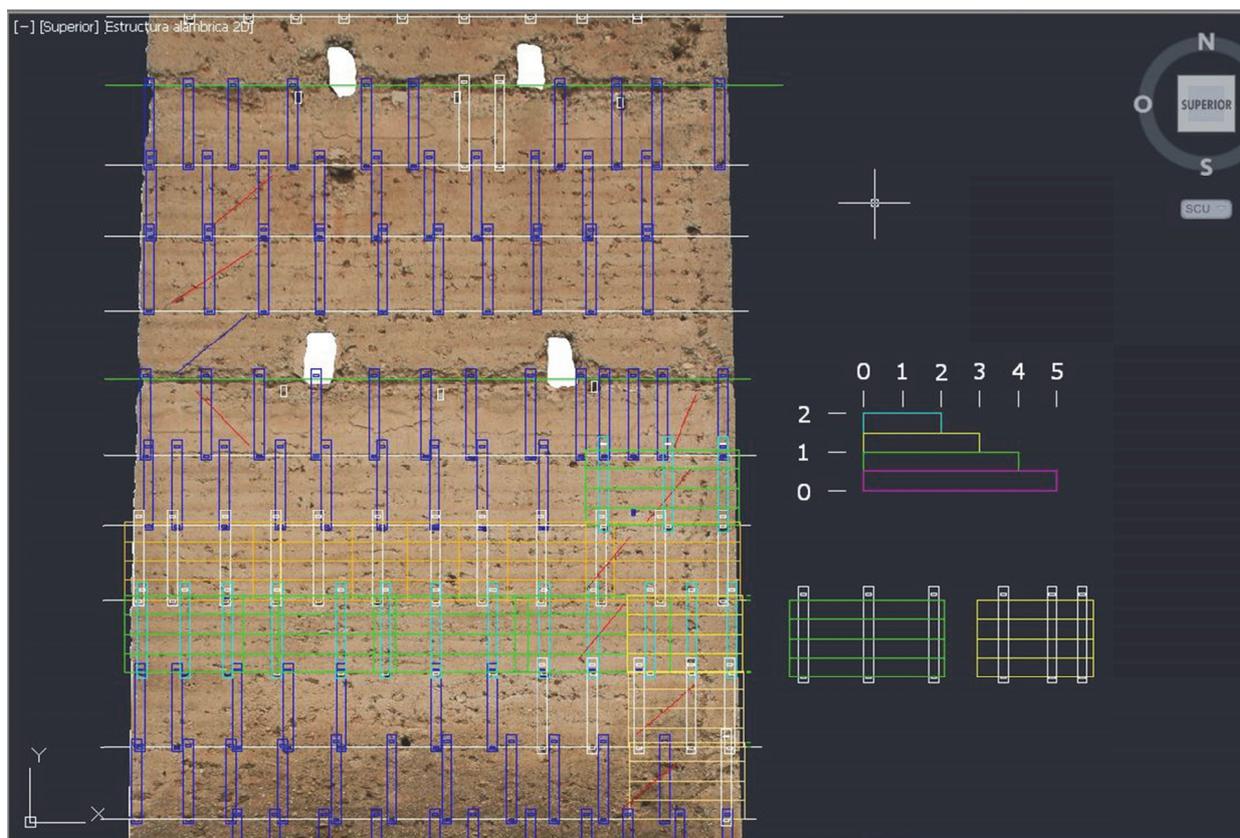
Superposición del módulo de tapial ideal sobre los alzados de la torre con la imagen fotogramétrica rectificada, en la que puede apreciarse la sucesión del encofrado.
